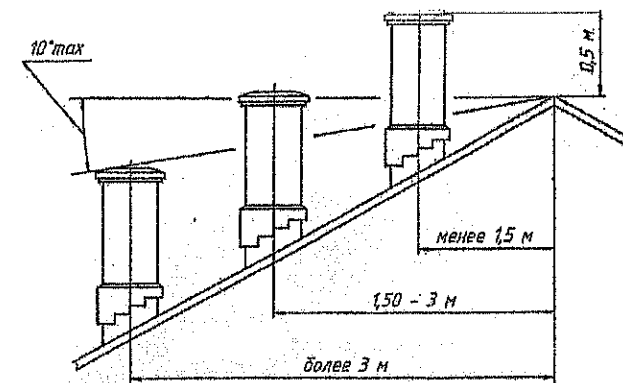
Расположение дымовой трубы относительно конька крыши
